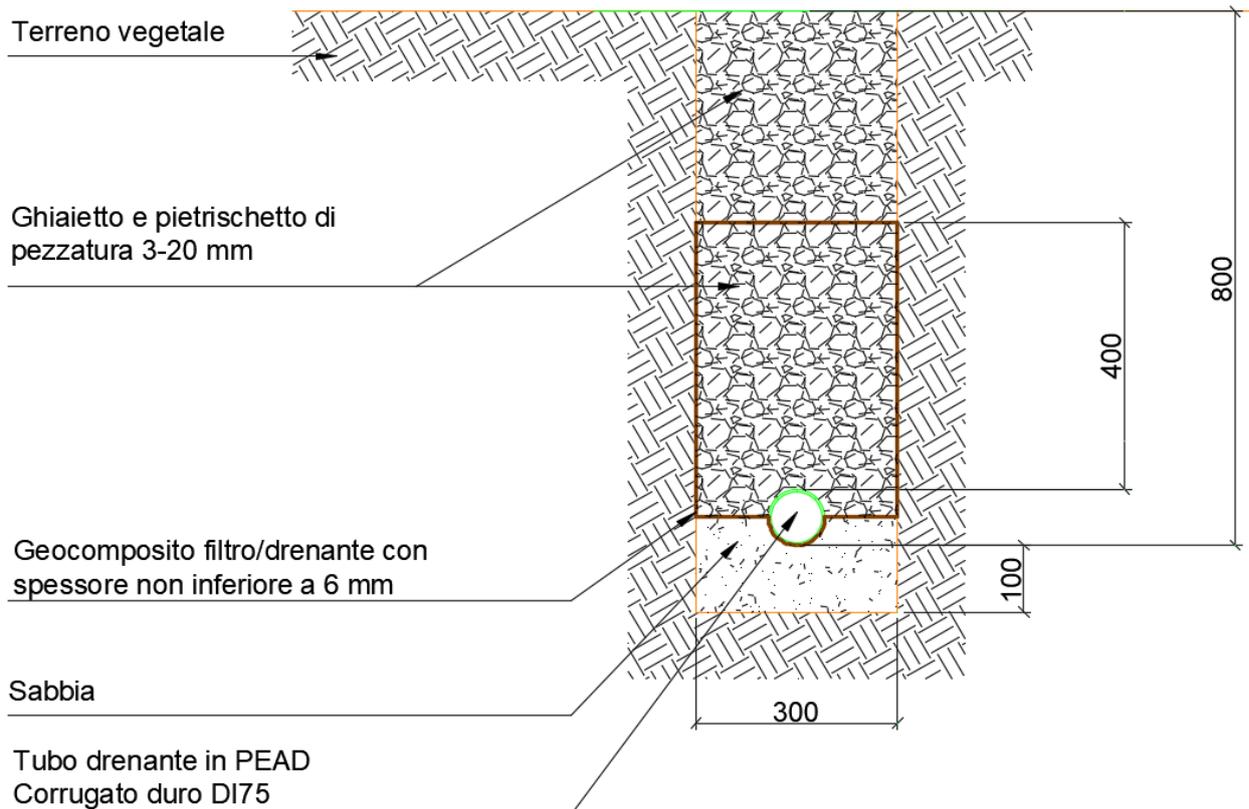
Sezione trincea drenante con tubazione DI 75 e riempimento dello scavo con ghiaietto e pietrisco di pezzatura 3-20 mm
